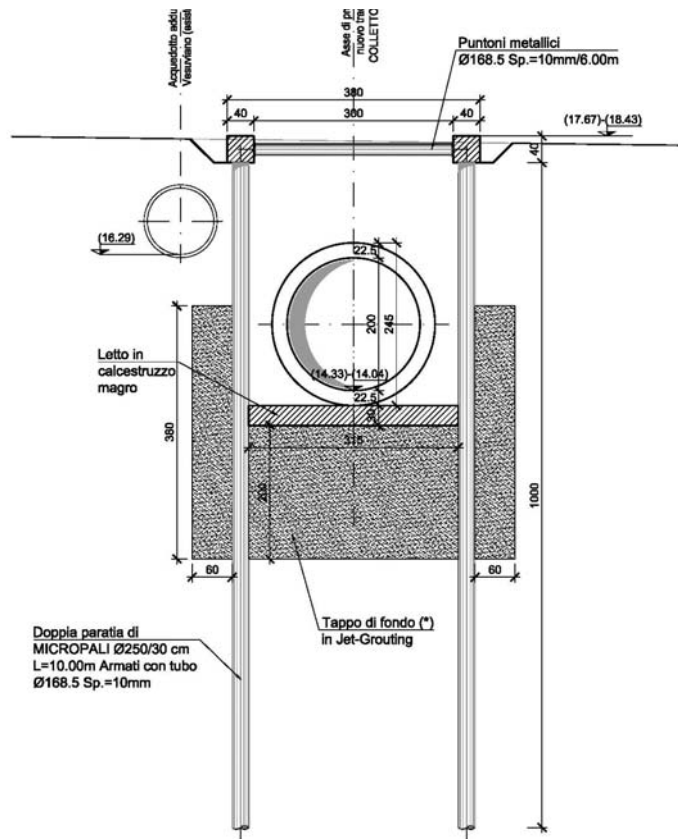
Opera IN08 - Sezione Trasversale tratto A-B
